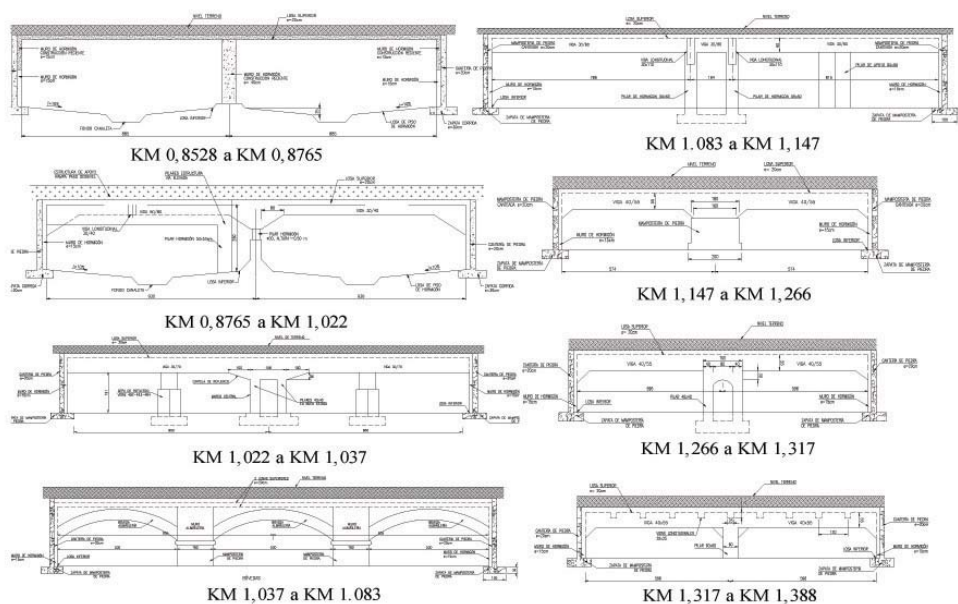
FIGURA : Tipologías de estructuras existentes en el cauce entubado
